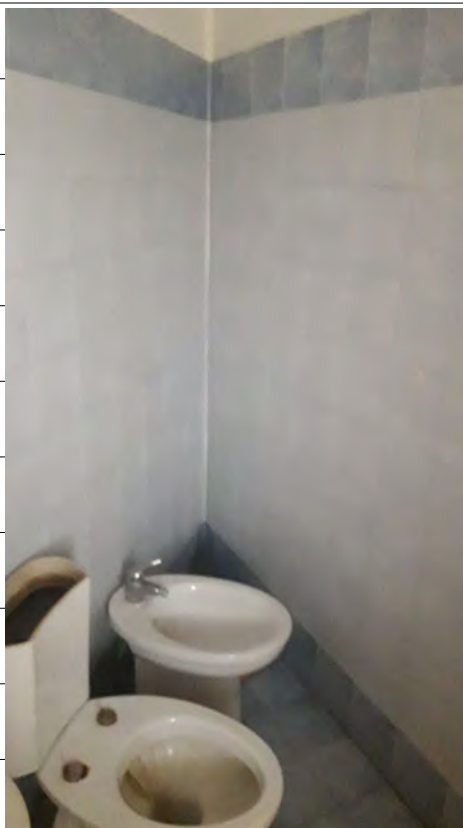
immagine interna del locale adibito a wc ubicato al primo piano dell'edificio.
